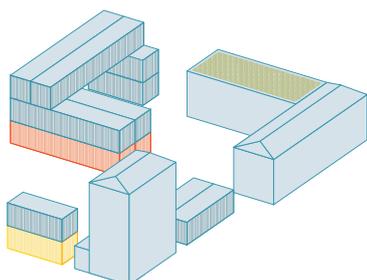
Lageplan Vertiefungsbereich S21-Fläche (Eigene Darstellung)
